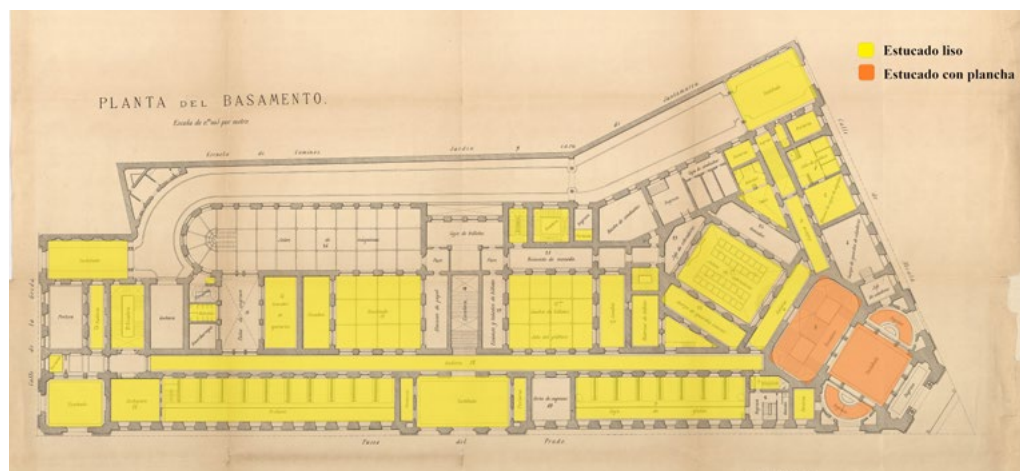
Estucos en la planta de basamento del edificio en 1891, actualmente perdidos (AHBE. Colección de Planos de arquitectura, 76/2,2)
